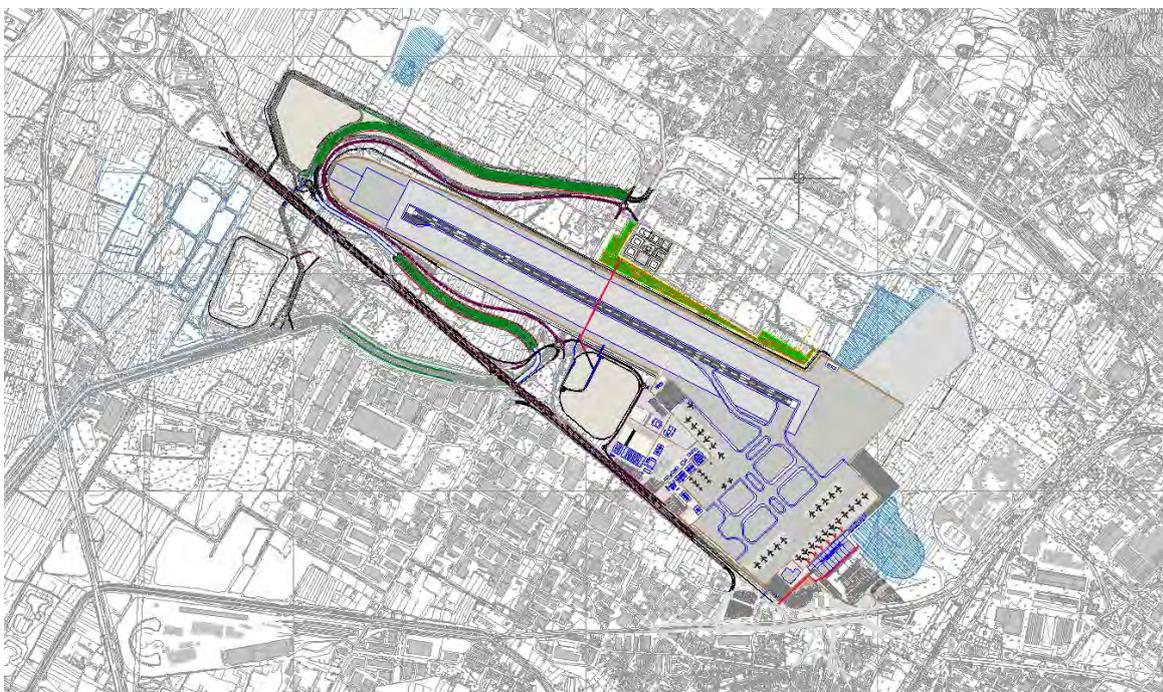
stralcio della planimetria di progetto dell'Aeroporto "Amerigo Vespucci"
